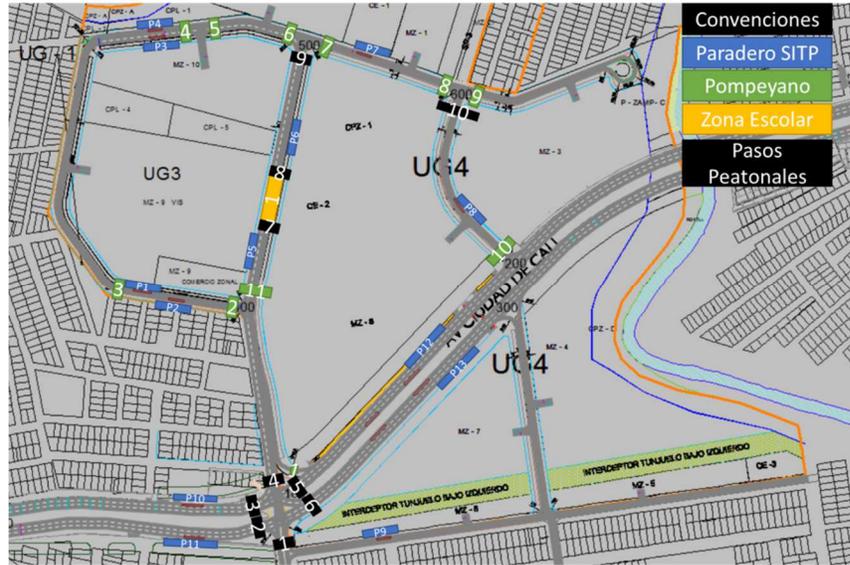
Esquema de paraderos, pompeyanos y zona escolar.
